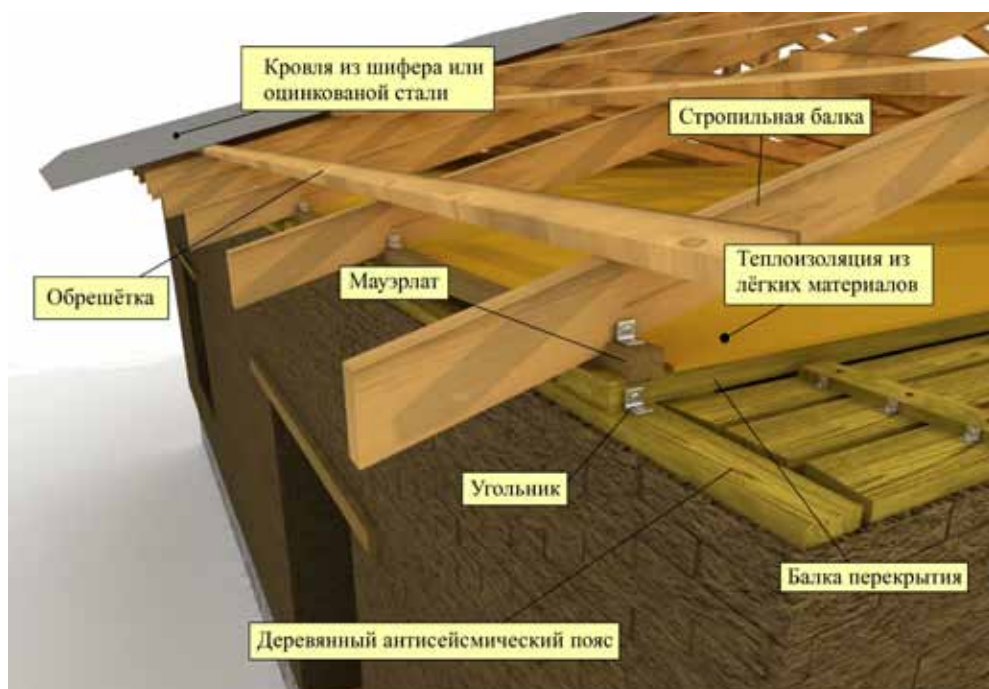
Крепление балок перекрытия и стропильной балки с мауэрлатом к антисейсмическому поясу
